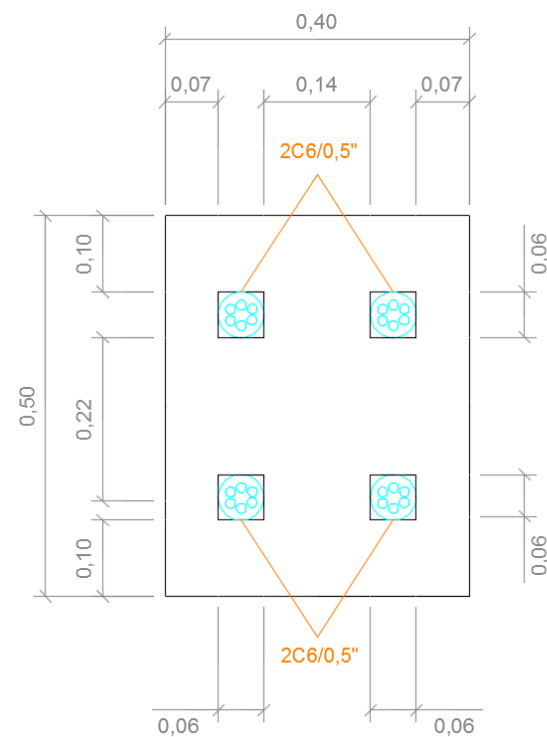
Sección tipo de la viga longitudinal en zona macizada
